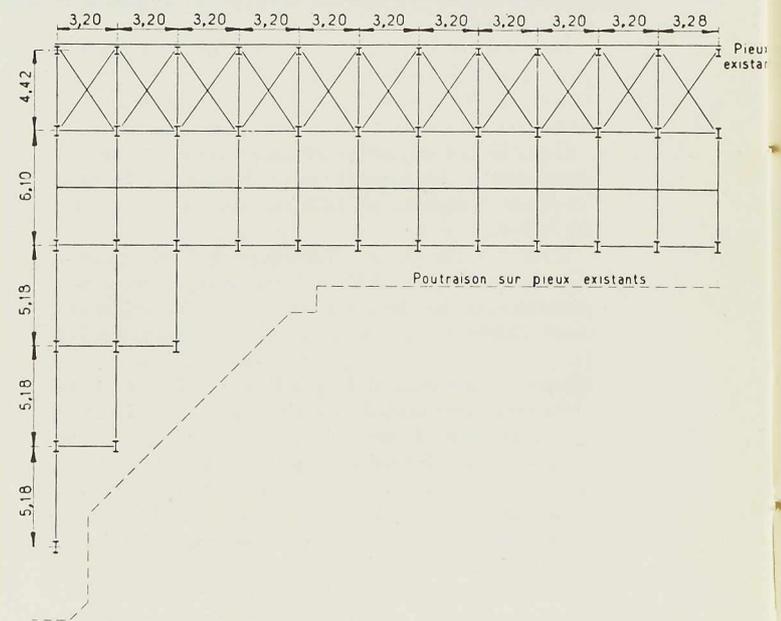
Vue en plan de la nouvelle partie du pier de Brighton.
